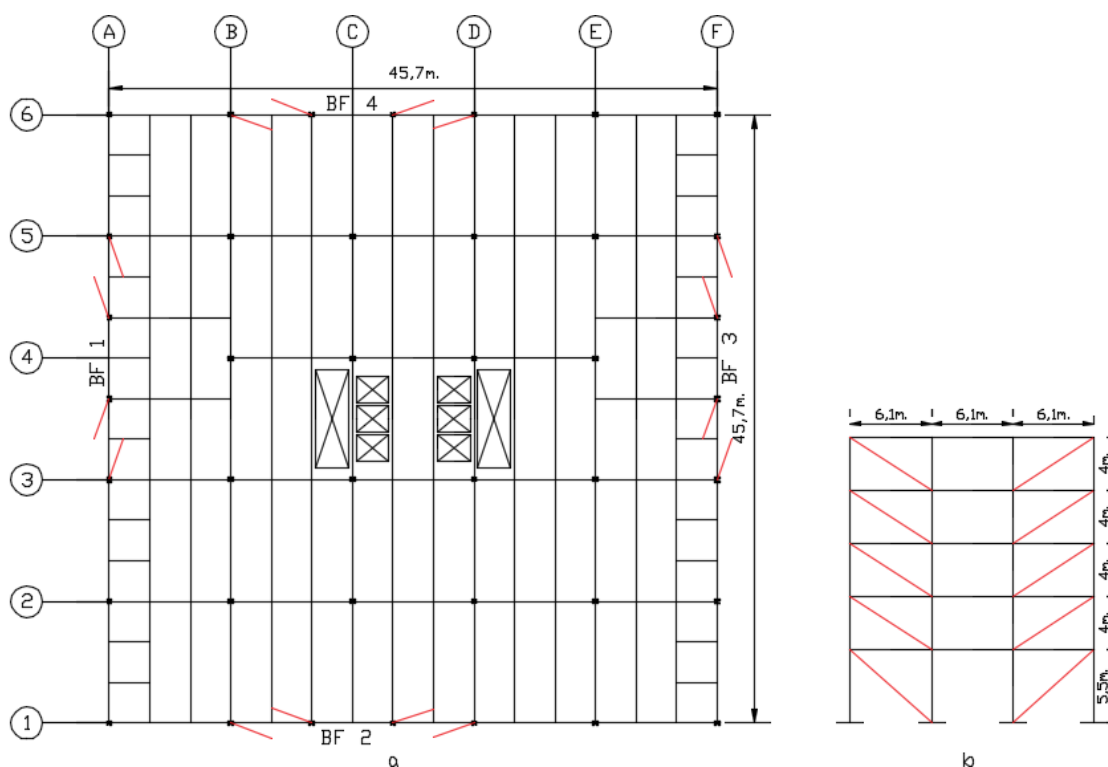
Modelo del edificio. a) vista en planta del edificio. b) Vista en elevación de pórtico arriostrado. (Adaptada). Tomada de (Bruneau, Uang, & Sabelli, 2011).
